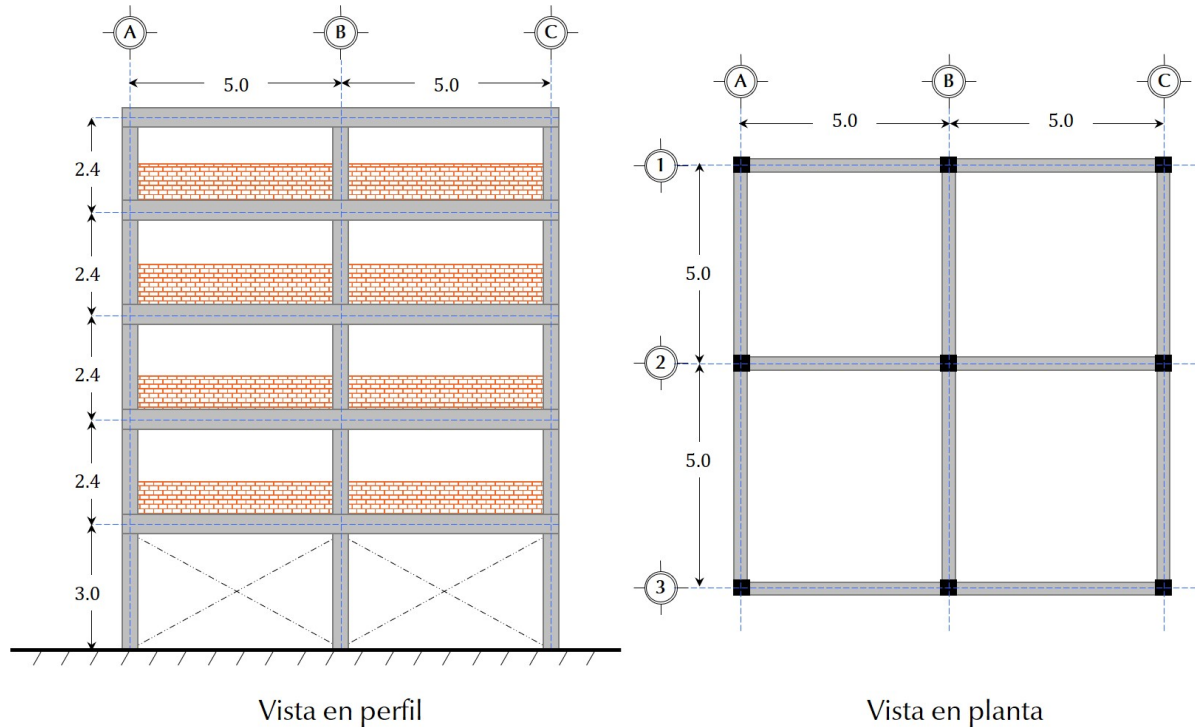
Vistas en perfil y en planta de la estructura de estudio
